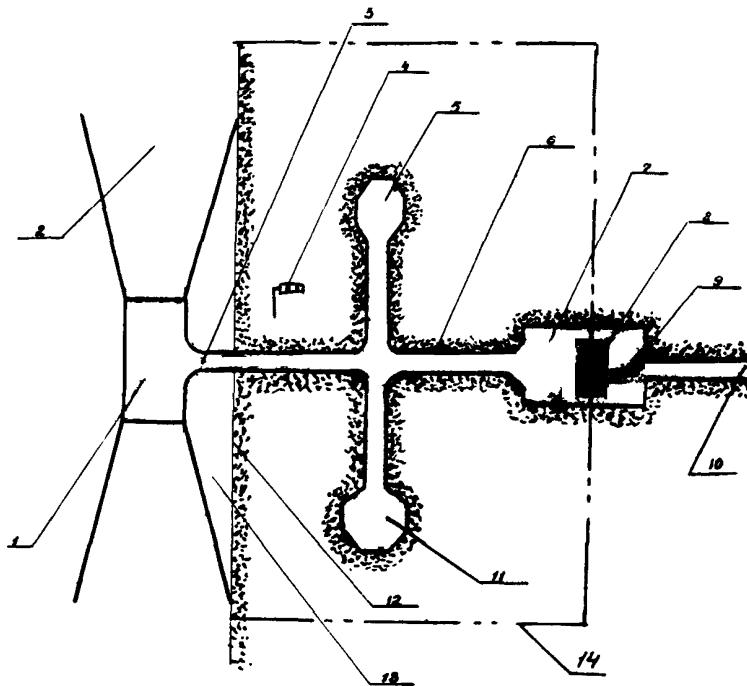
Схема генерального плана вертолетной станции с надводной взлетно-посадочной площадкой: 1 - взлетно-посадочная площадка; 2 - полоса воздушных подходов; 3 - трап для транспортировки вертолетов на берег; 4 - ветроуказатель; 5 - место стояния вертолета; 6 - рулежная дорожка; 7 - перрон; 8 - пассажирский павильон; 9 - привокзальная площадь; 10 - подъездная автомагистраль; II - швартовочная площадка; 12 - береговая линия; 13 - водоем; 14 - ограждение вертолетной станции
